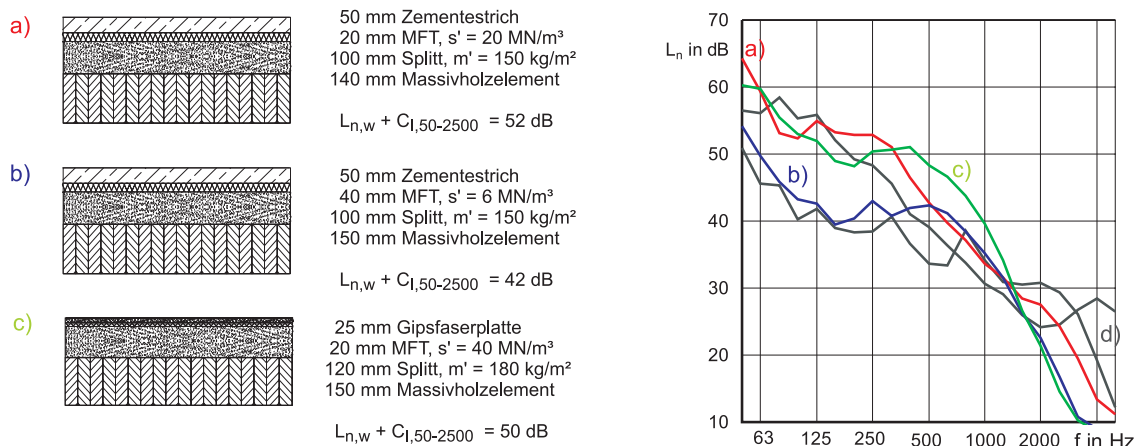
Messwerte der optimierten Massivholzdecken im Vergleich mit konventionellen Stahlbetondecken (d)
